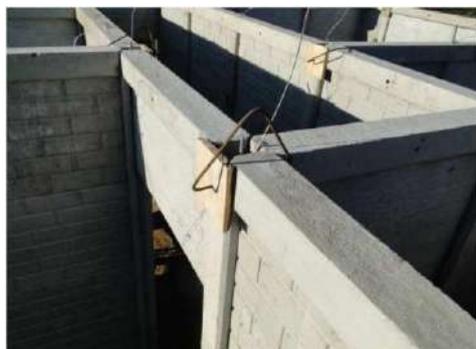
Preparación para el hormigonado del vano entre vigas sobre pilar.
